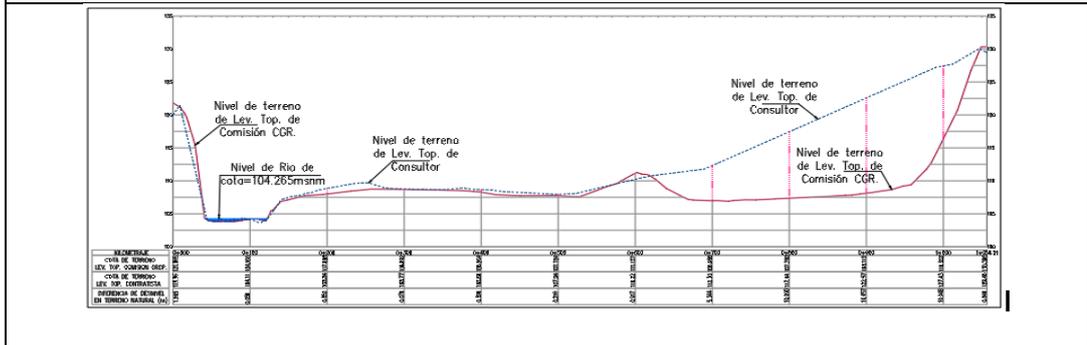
Comparación de perfiles longitudinales de terreno en la sección n.º18 entre levantamiento topográfico GRCP y levantamiento topográfico del Contratista (lámina de plano de Consorcio TS-18).
